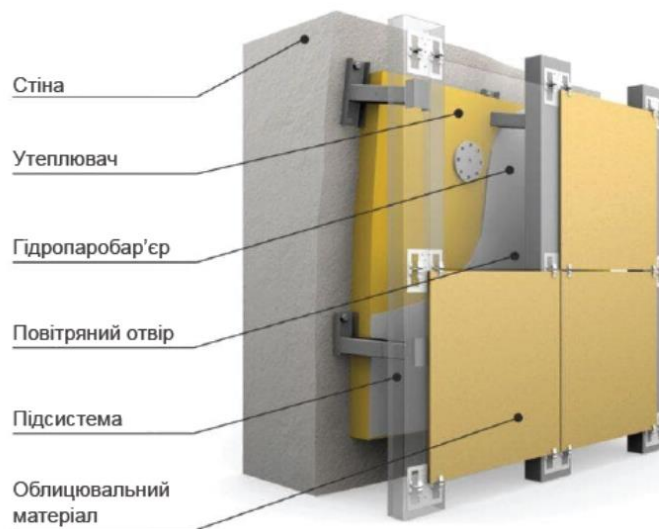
Конструкція кріплення за технологією «вентильований фасад»
